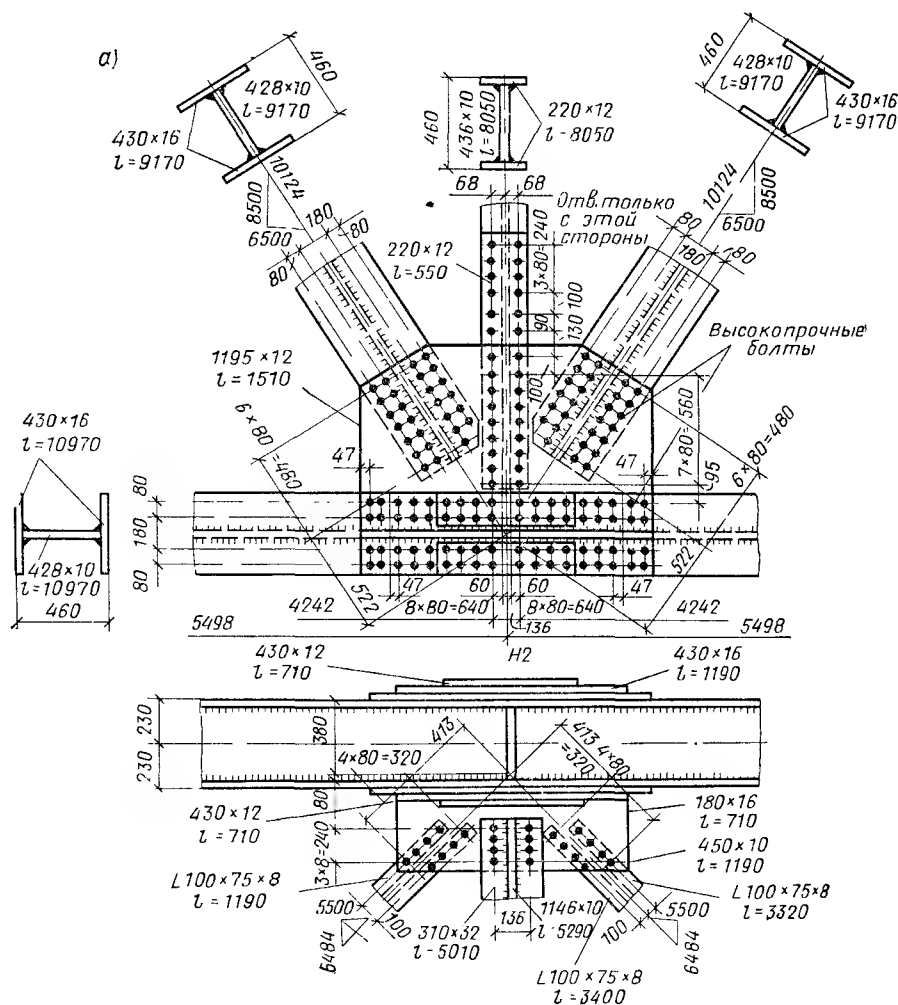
Узел сварной тяжелой фермы на высокопрочных болтах
